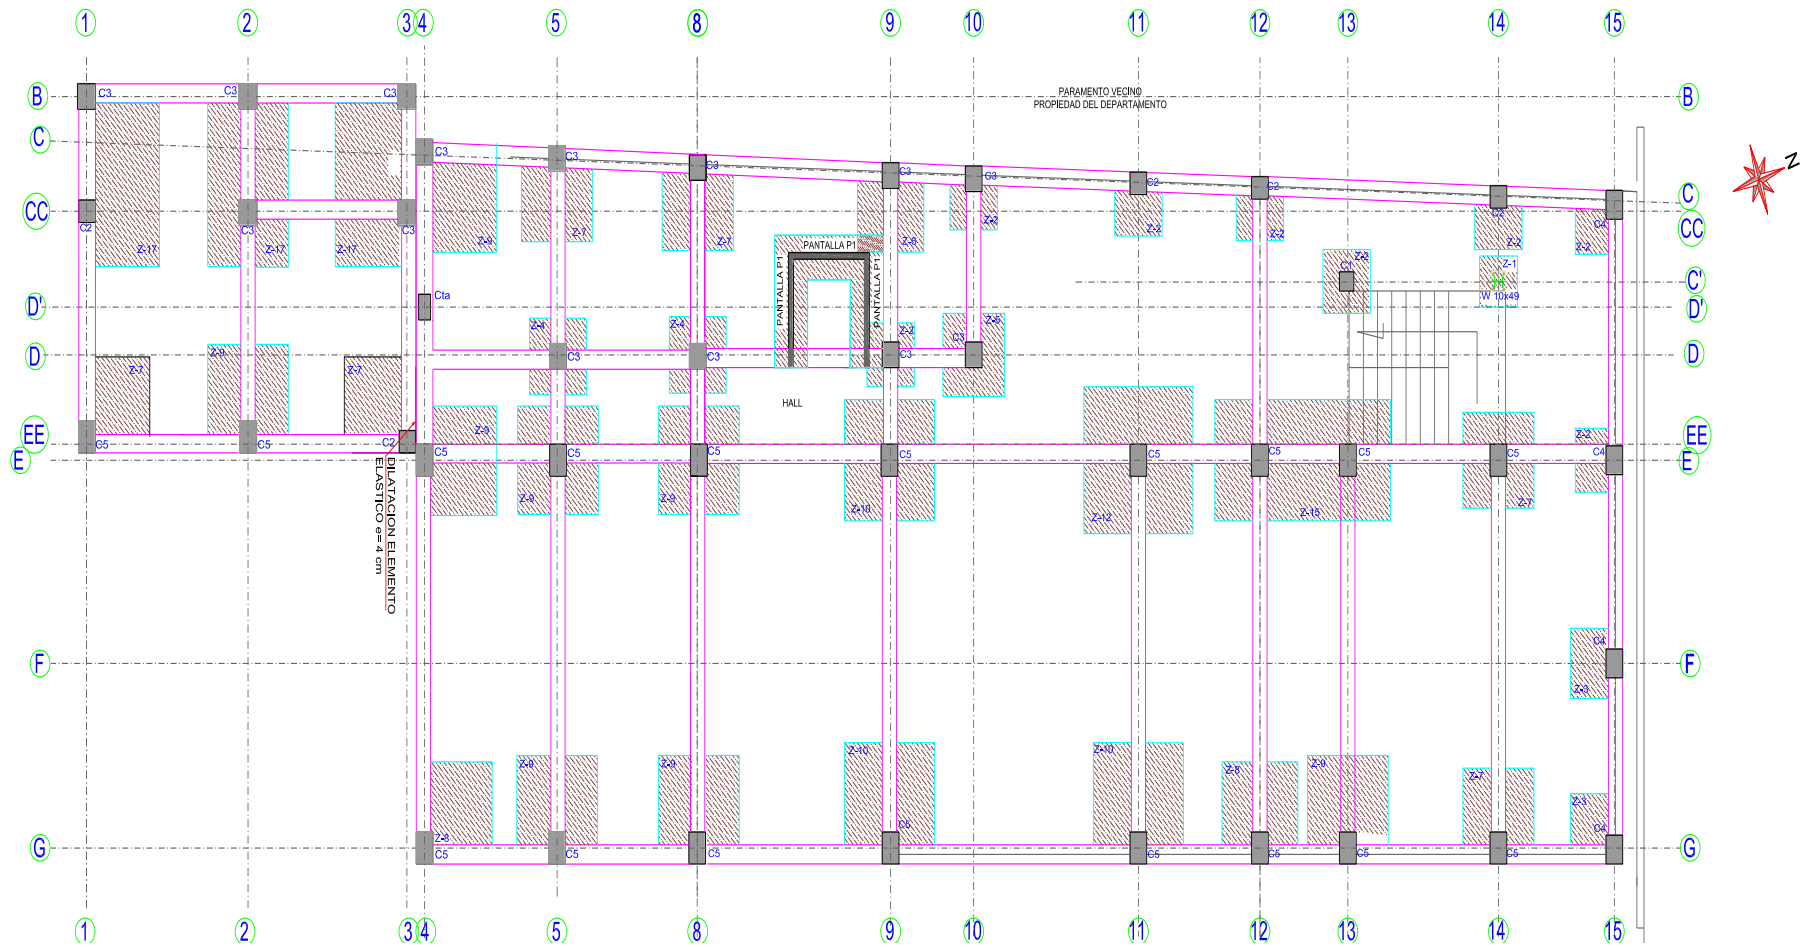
PLANTA DE ESTRUCTURA DE CIMENTACION BLOQUES 1 Y 2.
